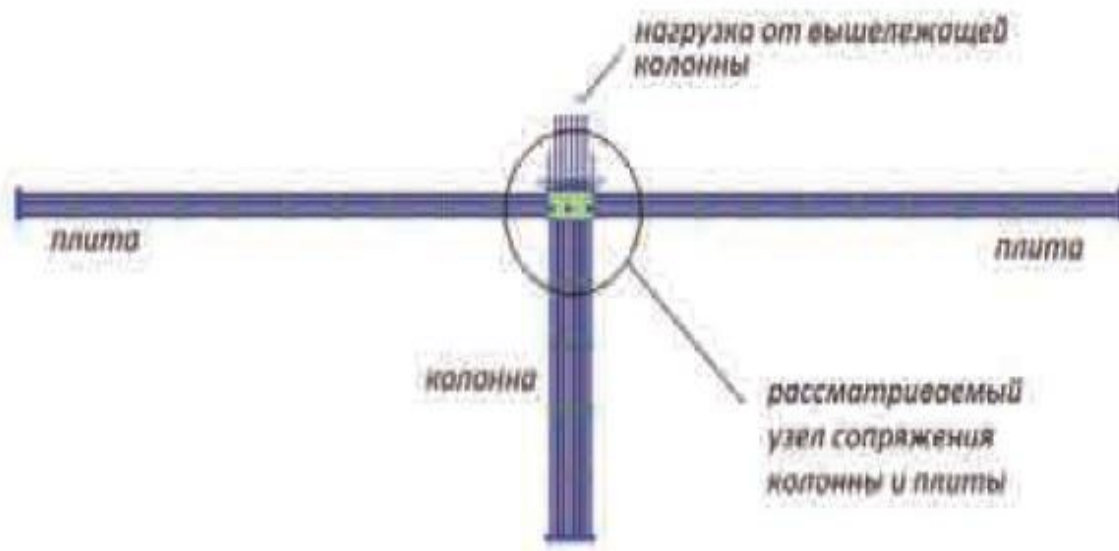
Розрахункова схема для дослідження напруженого стану стику плоского монолітного перекриття і колони багатоповерхової будівлі
